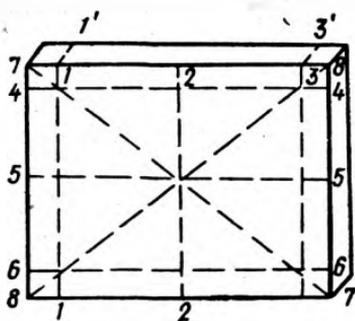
Определение неплоскостности бетонных и железобетонных изделий
